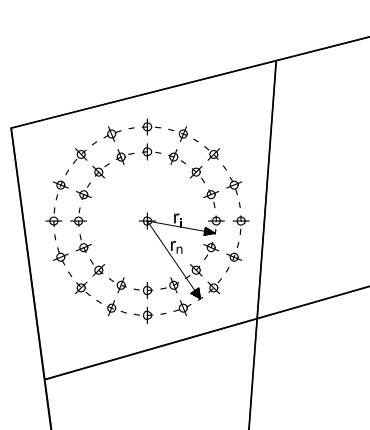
Empalmament semirígid d'una cantonada d'un pòrtic
